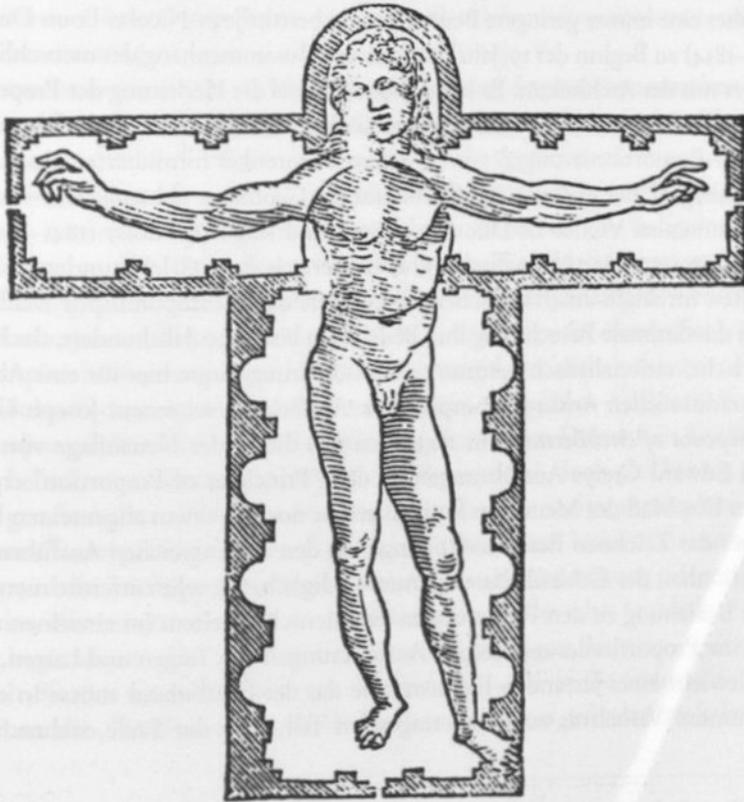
Pietro Cataneo, Proportionsfigur mit Kirchengrundriss, Architekturtraktat von 1567
